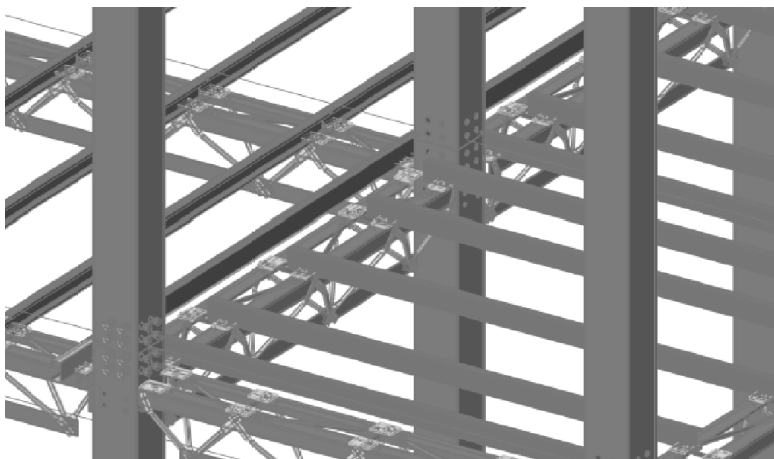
Exemplificação da ligação das vigas de piso em módulos dispostos perpendicularmente
